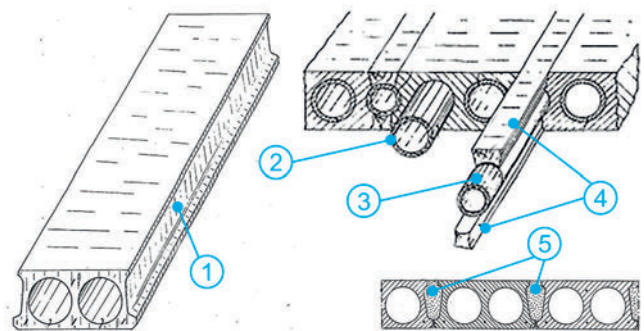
Dalle alvéolée Wetcast avec des tuyaux en caoutchouc renforcés amovibles [13] ; (1) profil de joint latéral dentelé, (2) tuyaux en caoutchouc avec renforcement central, (3) tuyau plus petit pour le profil de joint, (4) profil de coffrage supérieur et inférieur, (5) barre d'acier dans le joint
